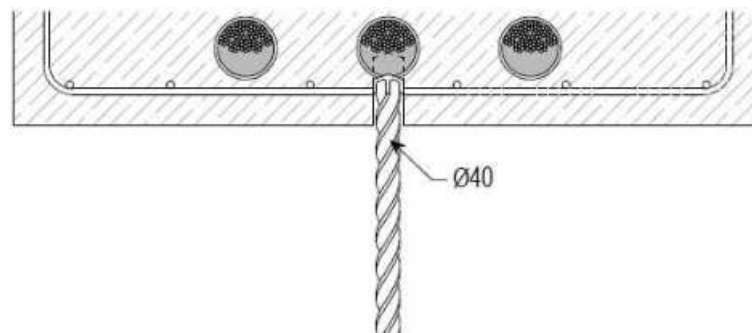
Stabilizační závrt do hloubky cca 5 mm
